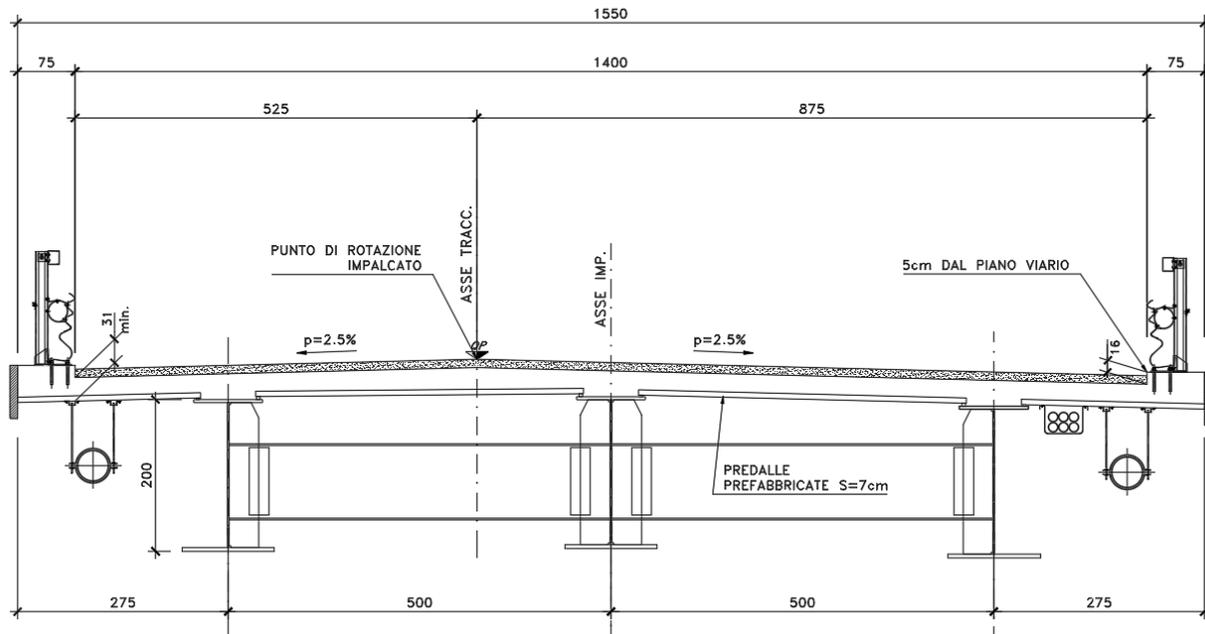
Sezione trasversale impalcato in campata tipo a 3 travi
